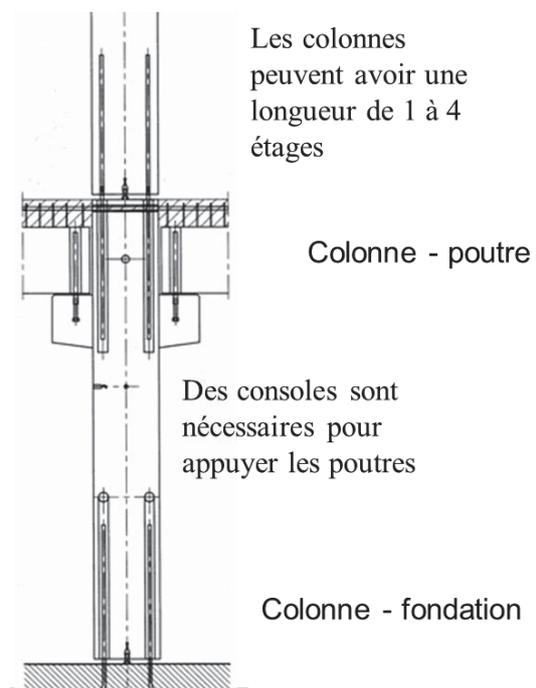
assemblage ave console Source (CONCEPTION DE CONSTRUCTIONS PREFABRIQUEES EN BETON.ppt)
